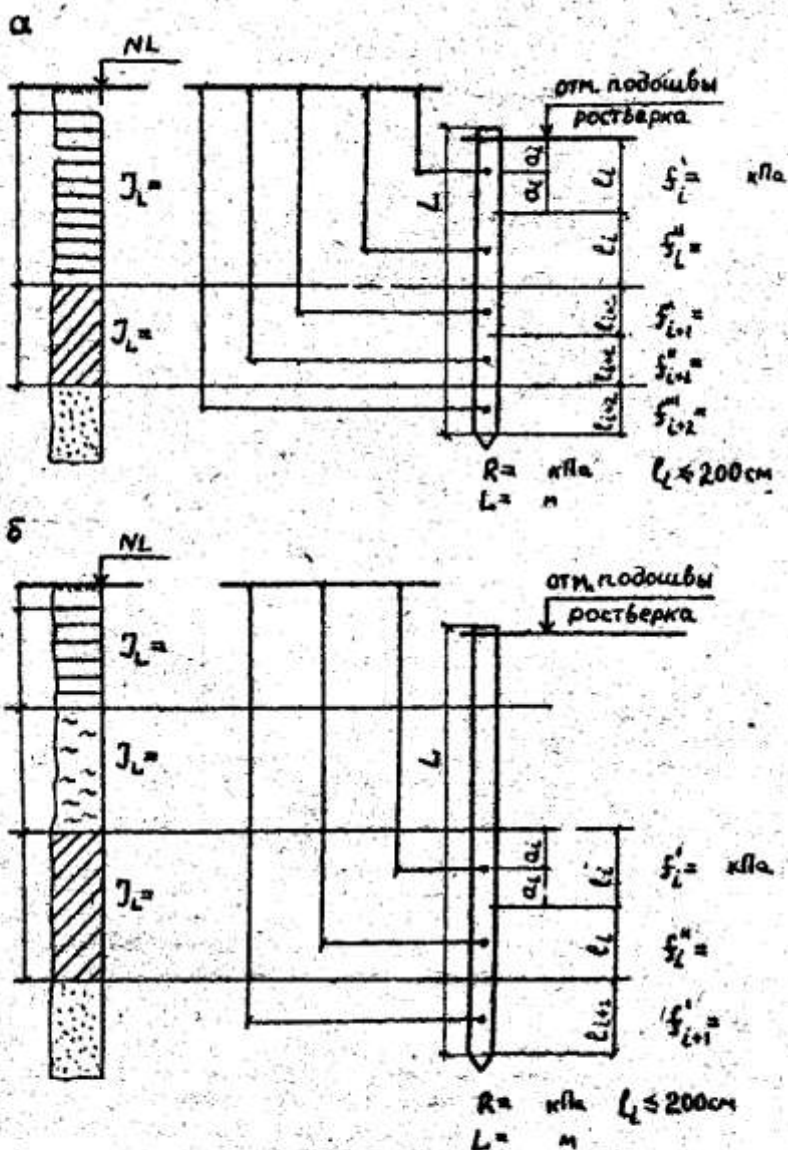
Схема для определения несущей способности одиночной сваи по грунту для фундамента Ф3 : а - без слабого слоя грунта; б - при наличии слабого слоя грунта (торф, ил)
